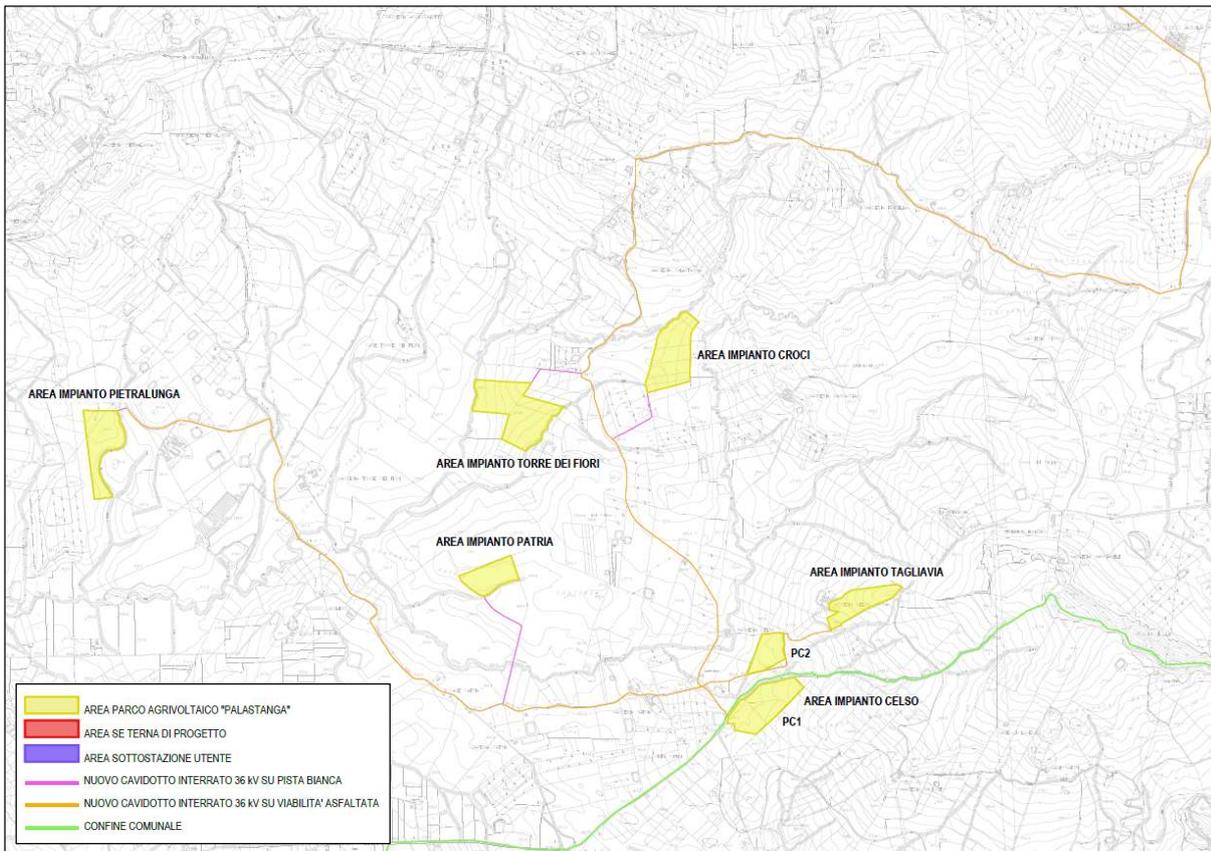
Inquadramento opere in progetto (impianto) su CTR (Scala 1:10000)
